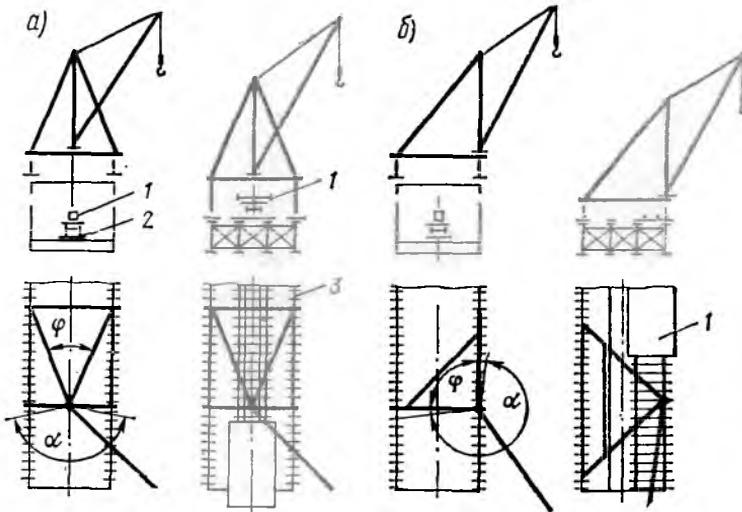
Схемы установки жестконогих деррик-кранов на пролетном строении: 1 — подаваемый к крану монтажный элемент; 2 — тележка; 3 — подкрановый путь
